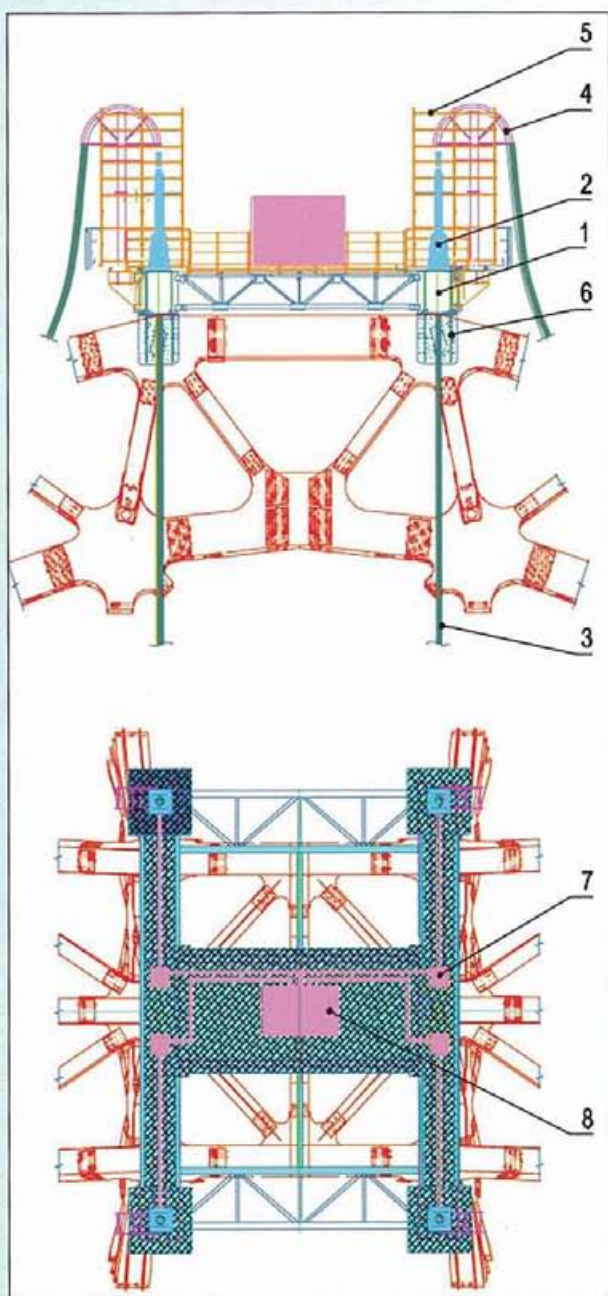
Схема расположения элементов устройства подъема: 1 – вспомогательные несущие балки для установки грузоподъемного оборудования; 2 – гидравлический домкрат SLV-350/550F; 3 – тянущий канат; 4 – устройство для отключения тянущего каната; 5 – рабочие площадки; 6 – опорные площадки для установки несущих вспомогательных балок; 7 – насосные станции; 8 – центр управления подъемом
